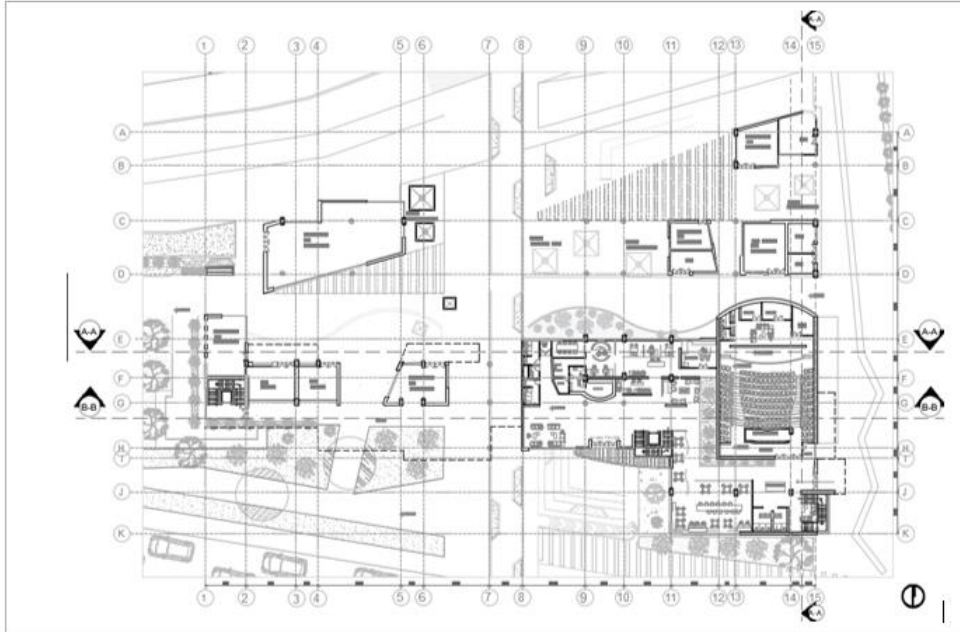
Propuesta planta primer nivel. Autoría propia (2020)
